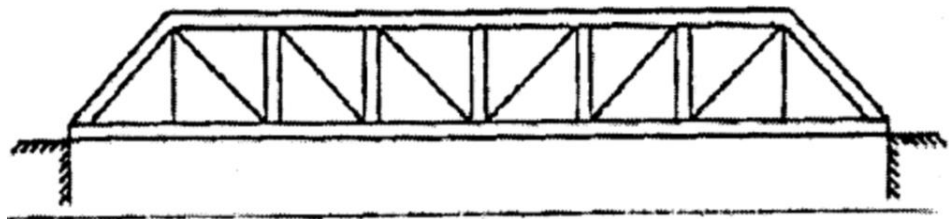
Jembatan Tipe Rangka Kayu (*Wooden Truss*)
